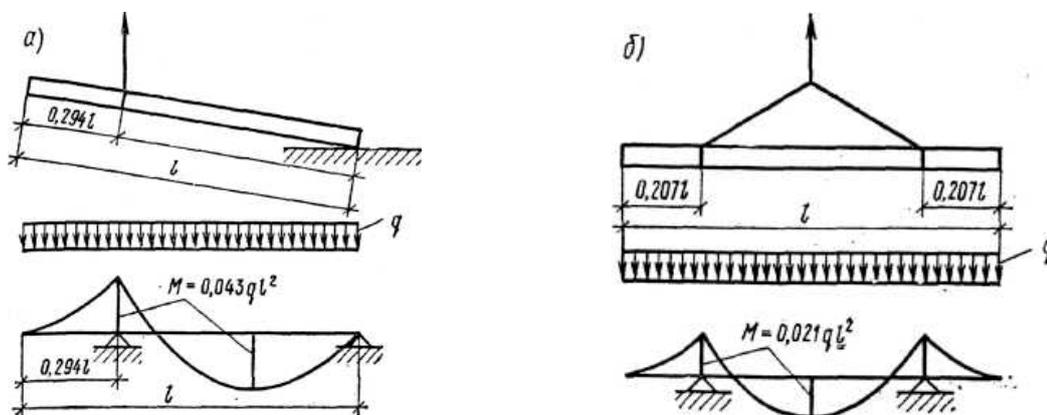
Схемы строповки и расчетные схемы свай
